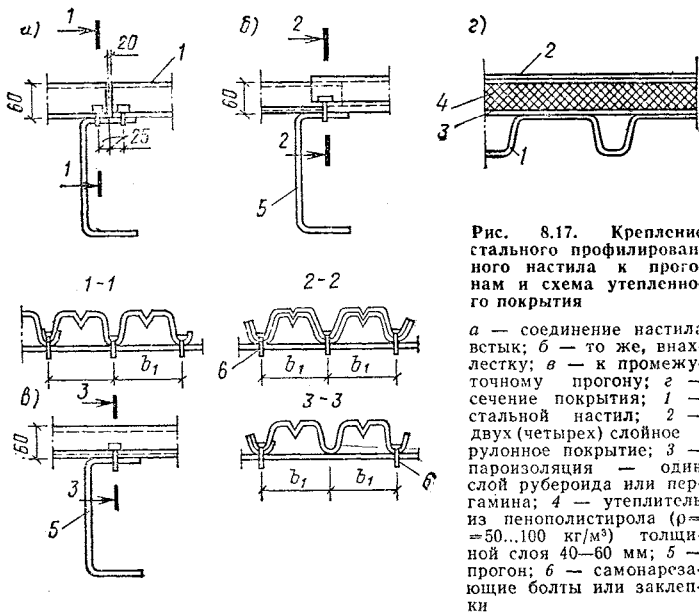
Крепление стального профилированного настила к проганам и схема утепленного покрытия
